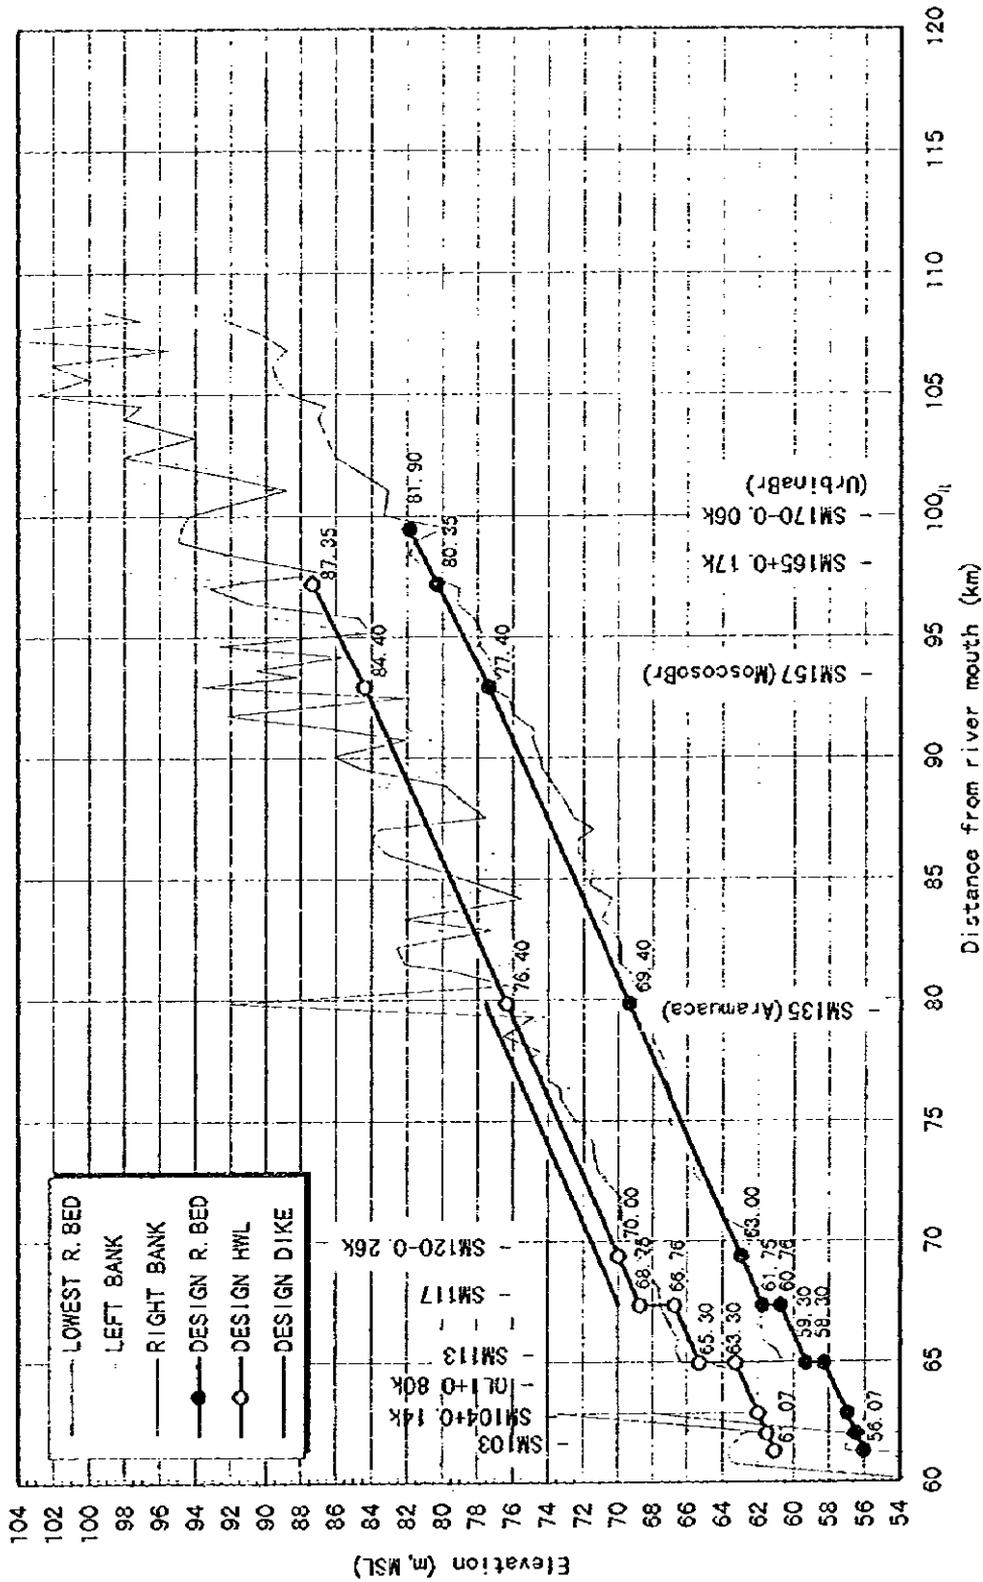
PERFIL DEL CANAL DISEÑO(2/3)
